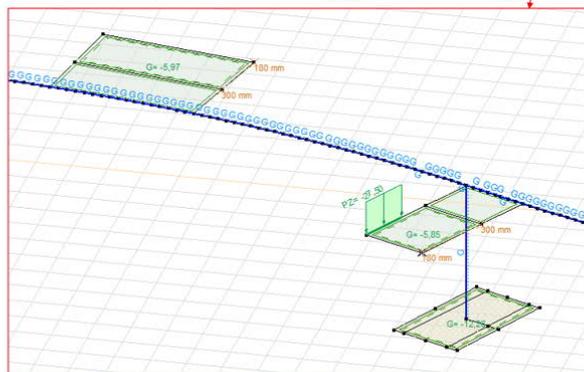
Eigenlast Stahlbetonkonsolen
